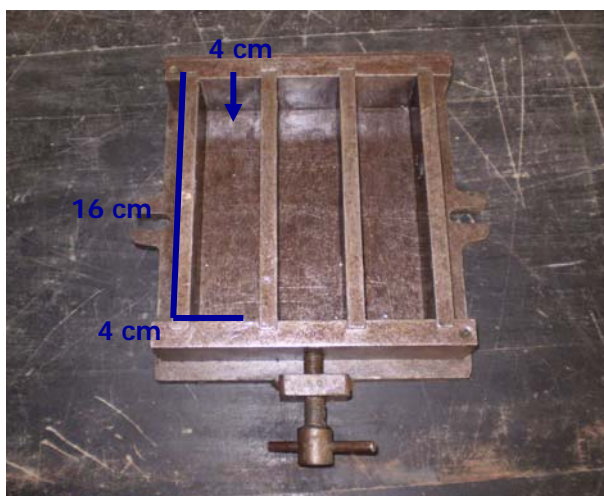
Dimensiones del molde 16 x 4 x 4 cm
